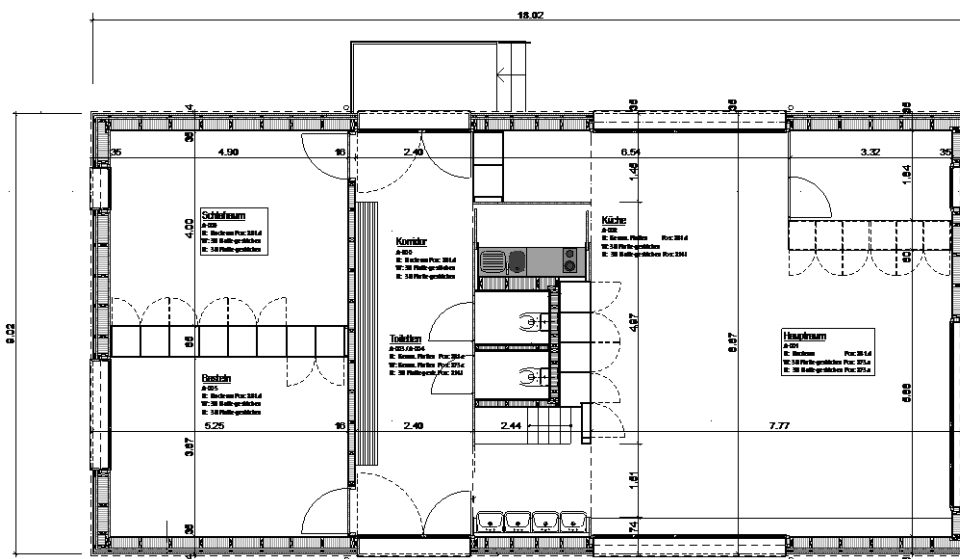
Grundriss KITA Inselspital, nicht massstäblich
